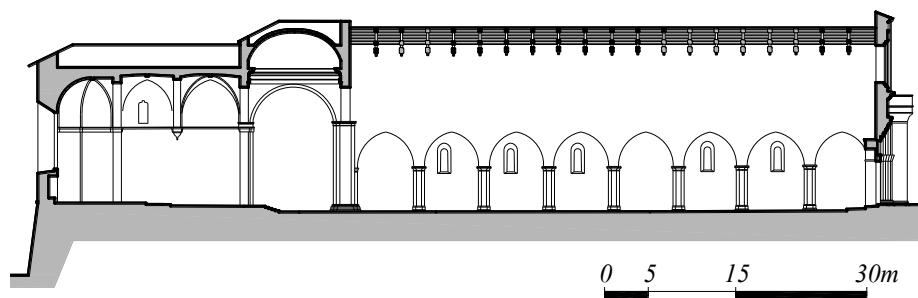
Basilica di Collemaggio: Sezione longitudinale
